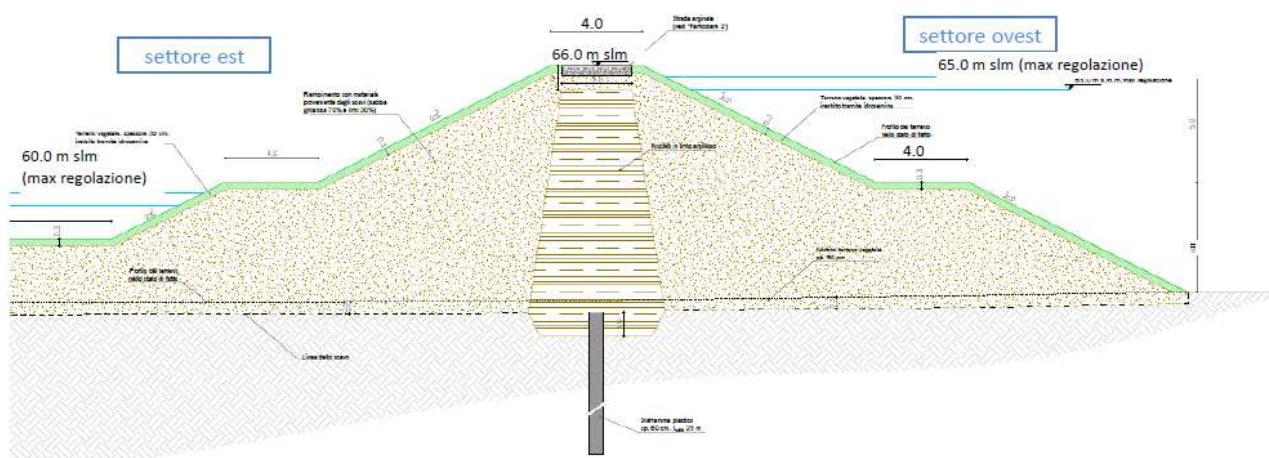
Sezione tipo dell'argine di separazione tra le due casse nel tratto con diaframma plastico.
